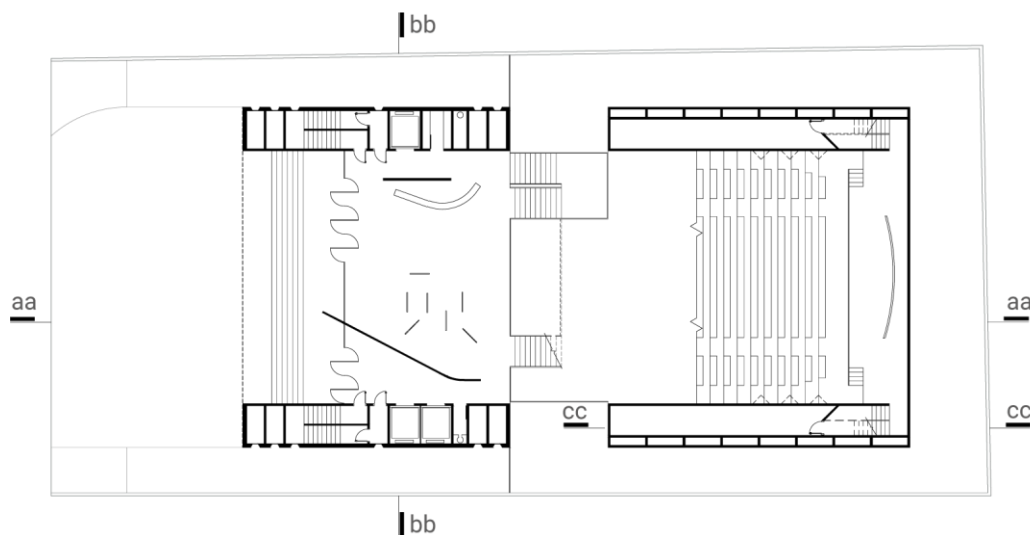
Sede para a SBPC (1978, 1º lugar): redesenho da planta do pavimento térreo. Fonte: autores.
